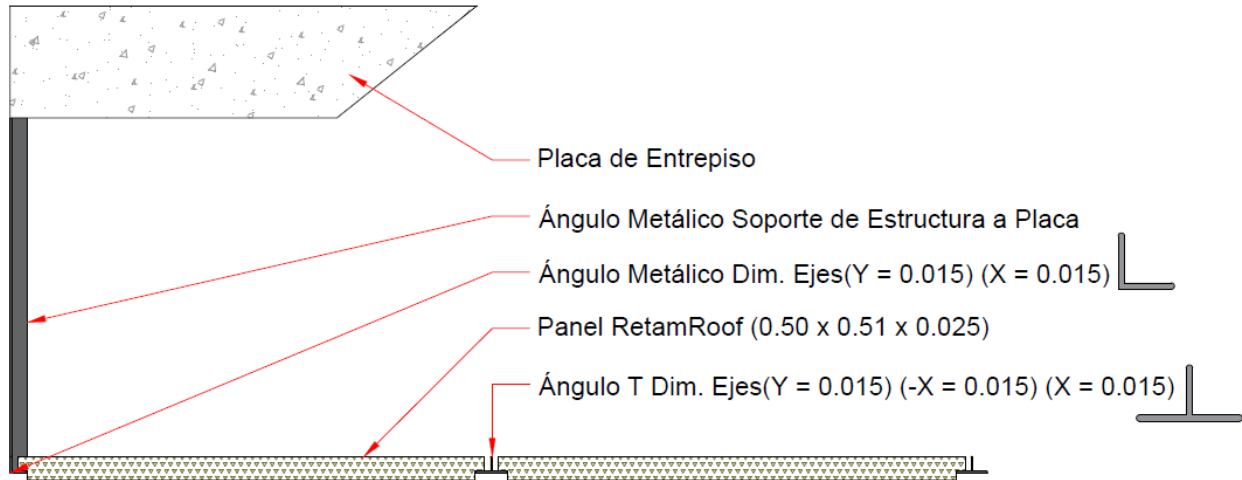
Detalle y Corte de estructura modular para la instalación de Paneles RetamRoof elaborados por ECOSINV Construction and Sustainability
